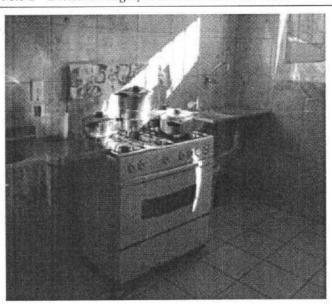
Cozinha após a retirada da divisória entre a cozinha e a lavanderia
